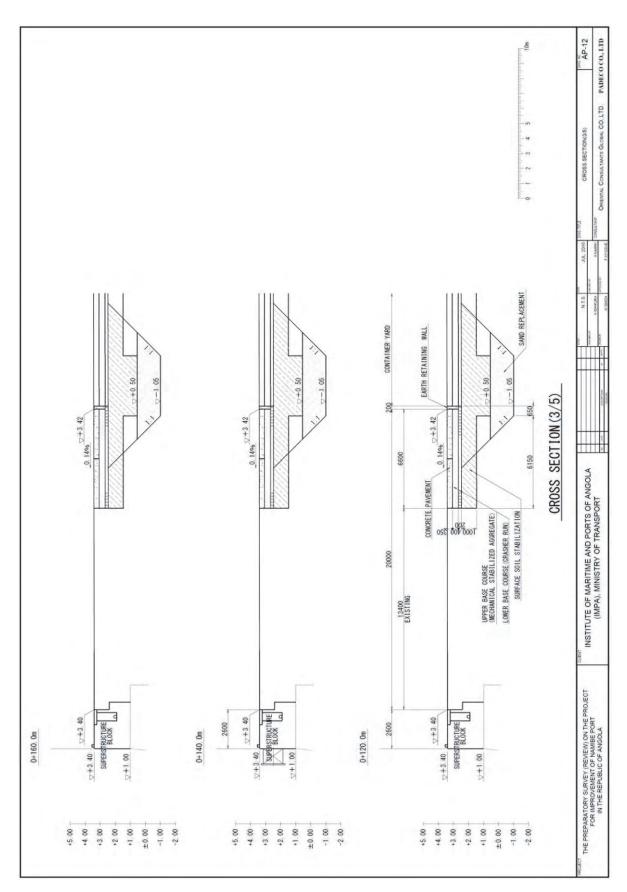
Corte Transversal do Cais e da Estrutura sobre o Muro
